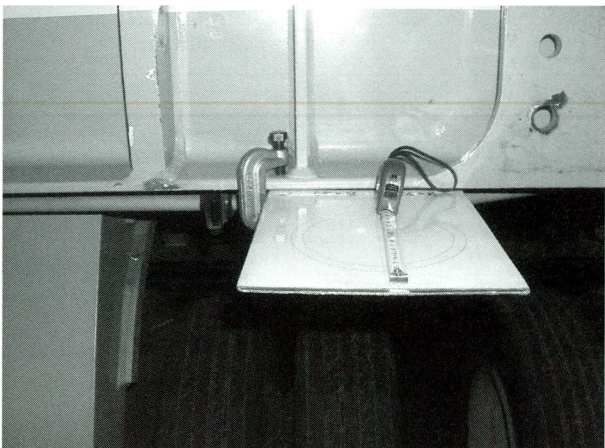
レーザー下げ振りによるデッキリフトの傾きの計測状況
